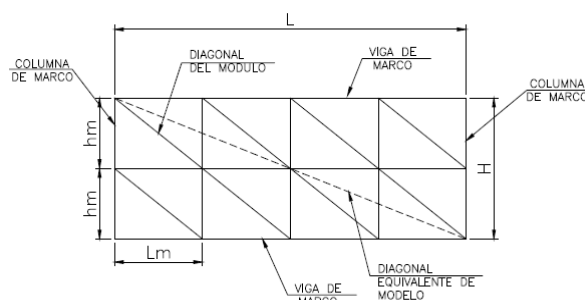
Croquis del modelo del puntal de mampostería adaptado.
